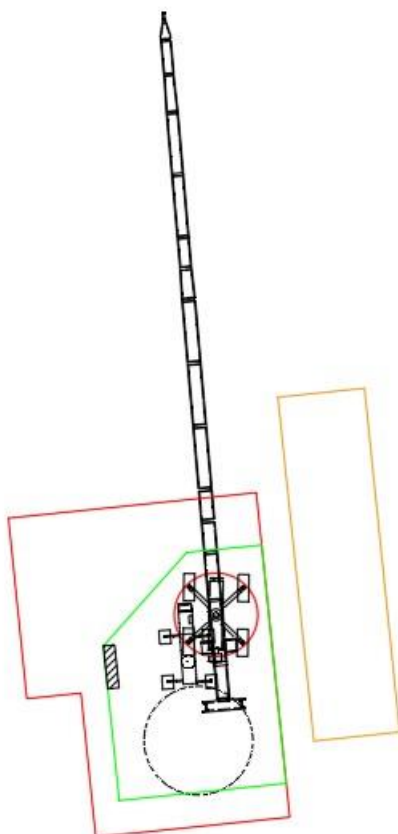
Posizione Cabina di raccolta e vista in pianta con gru da 200t
